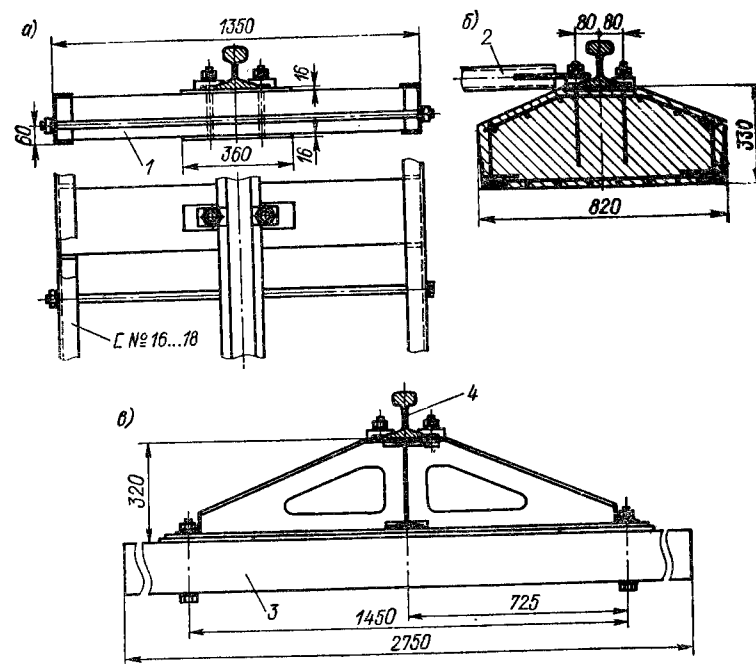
Крановые пути для башенных кранов: а — на деревометаллических рамах конструкции Главмостроя; б — на бетонных балках; в — на металлических рамах конструкции ВНИИстройдормаша; 1 — полушпала типа 1А; 2 — стяжка из трубы; 3 — шпала типа 1А; 4 — рельс Р50
